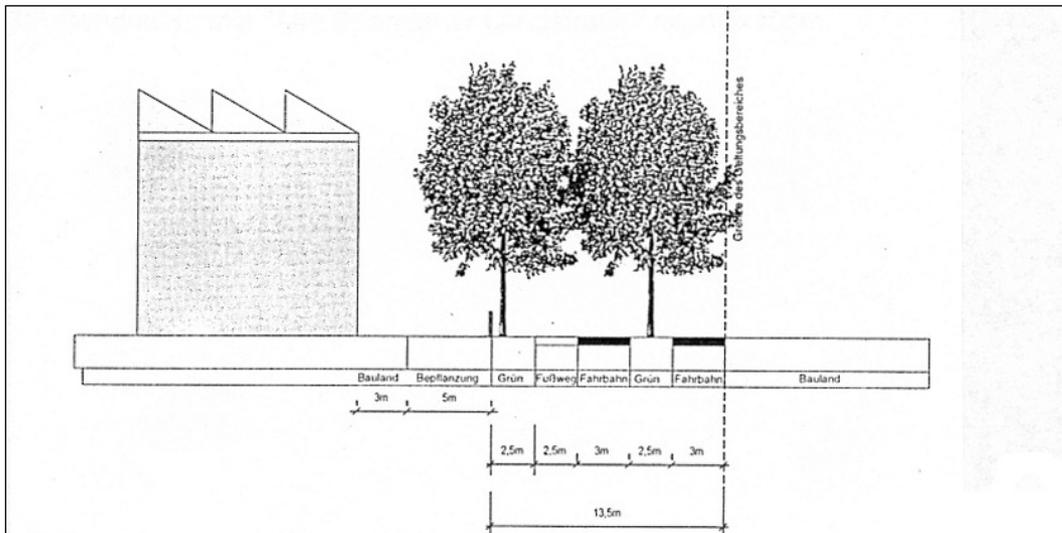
Straßenquerschnitt "Alte Spandauer Landstraße"
